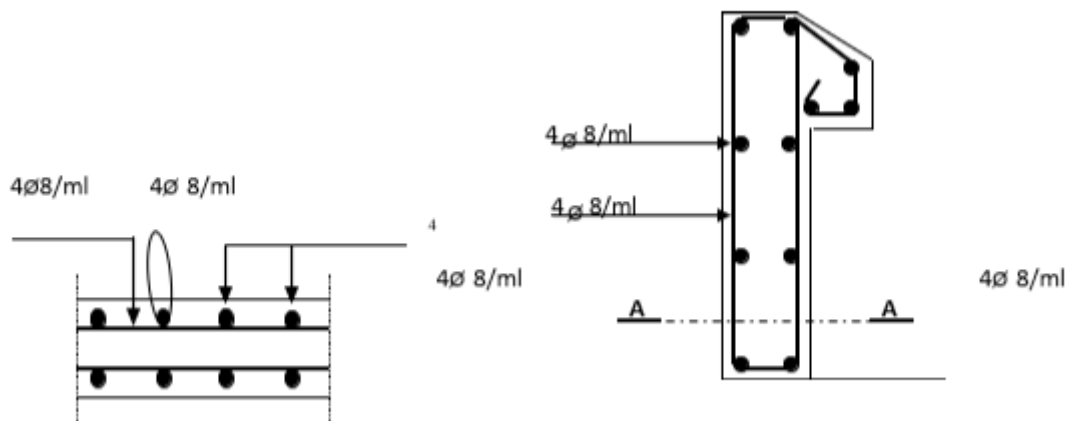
Schéma Du Ferrailage D'acrotère
